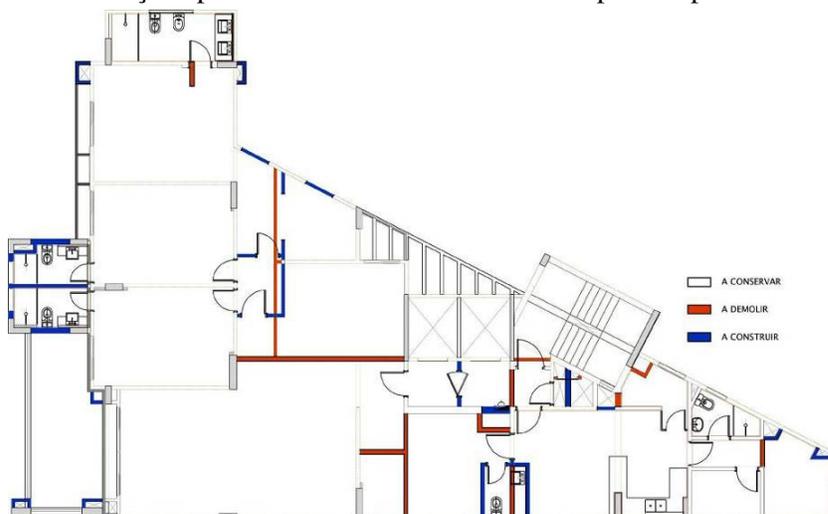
Planta de construir e demolir do Edifício Paulistano
